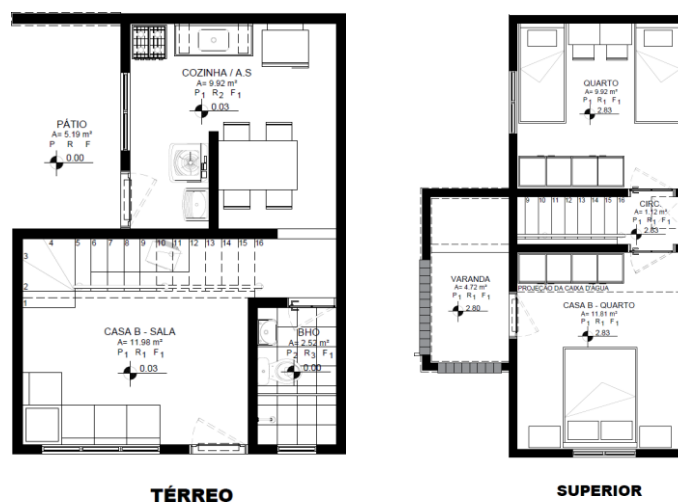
Planta-baixa Tipo B. Fonte: Aflalo (2016)
